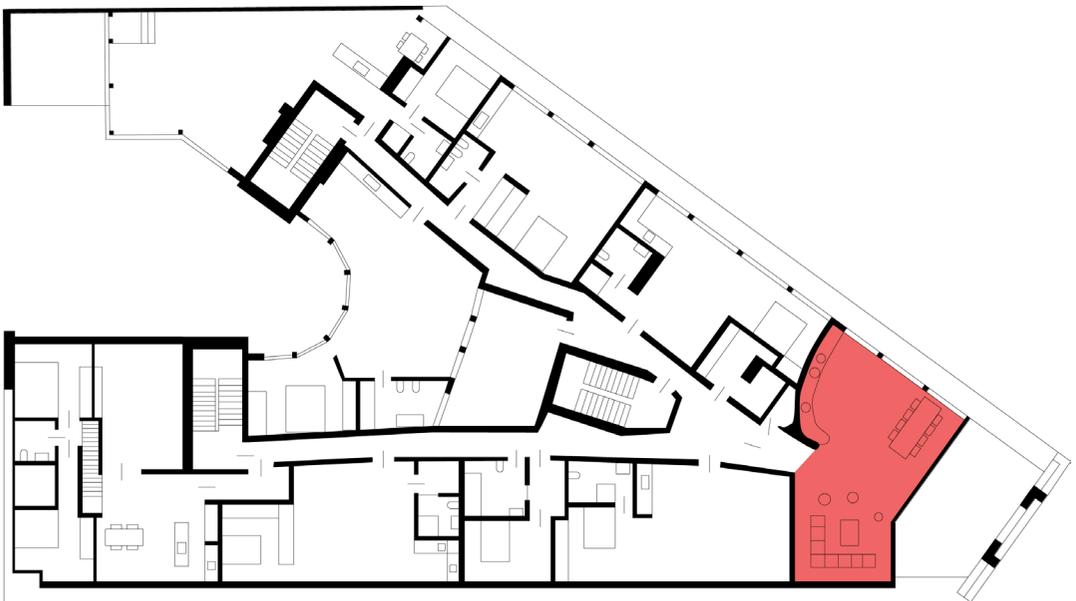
Am Maybachufer, Grundriss Großwohnung
